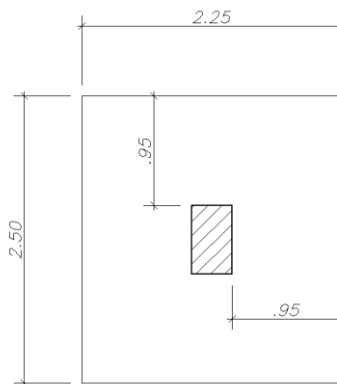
Vista en planta y dimensiones de zapata para columna P-1
